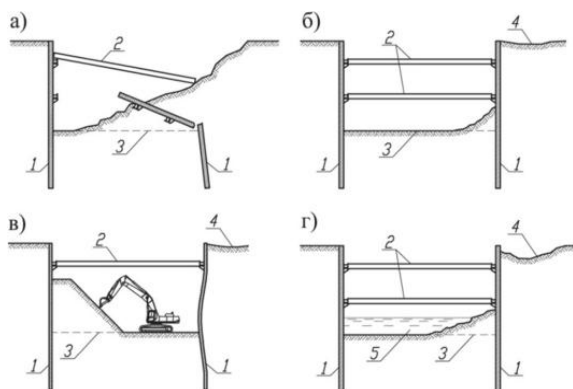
Аварійні ситуації у будівництві тунелів відкритим способом: а – руйнування захисної конструкції; б – локальний вивал ґрунту в котлован; в – надмірні деформації захисної конструкції; г – прорив ґрунтових вод у котлован із виносом ґрунту; 1 – захисна конструкція; 2 – розстріли; 3 – дно котловану; 4 – опади поверхні землі; 5 – ґрунтова вода
